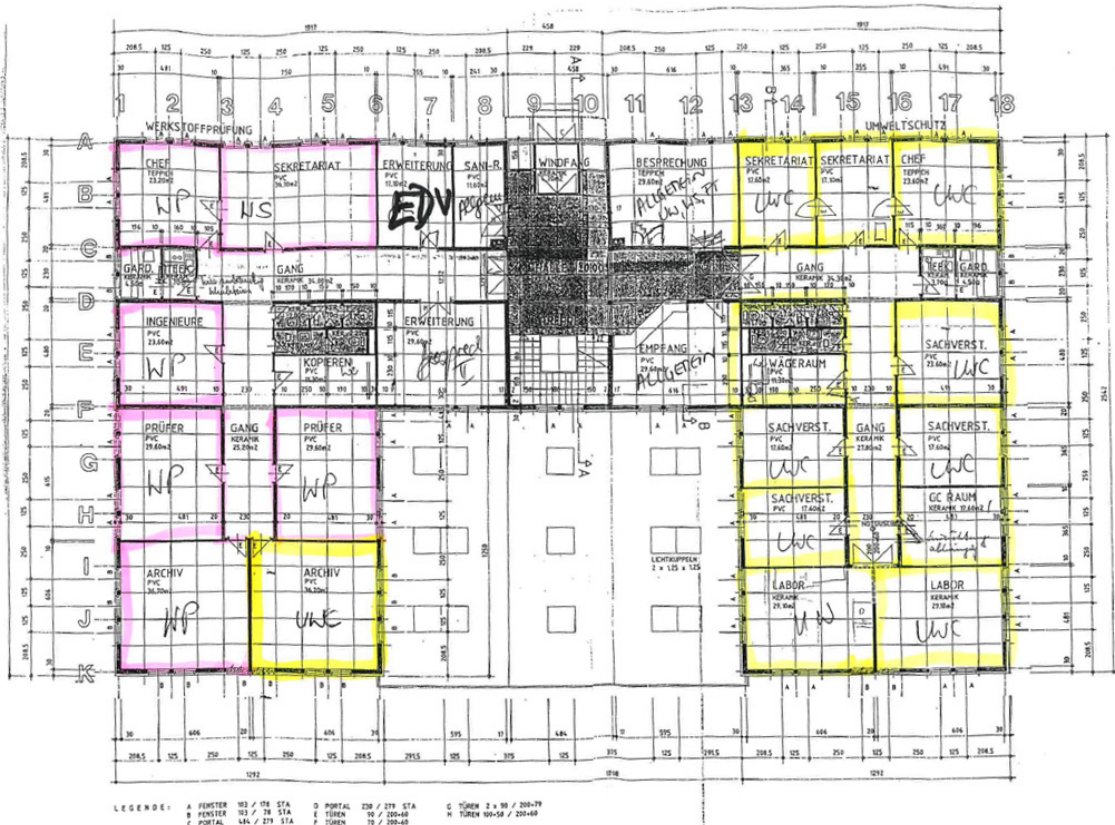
, Abbildung 21 und Abbildung 22 zeigen den Grundriss des Erd-, Ober- und Untergeschosses.
